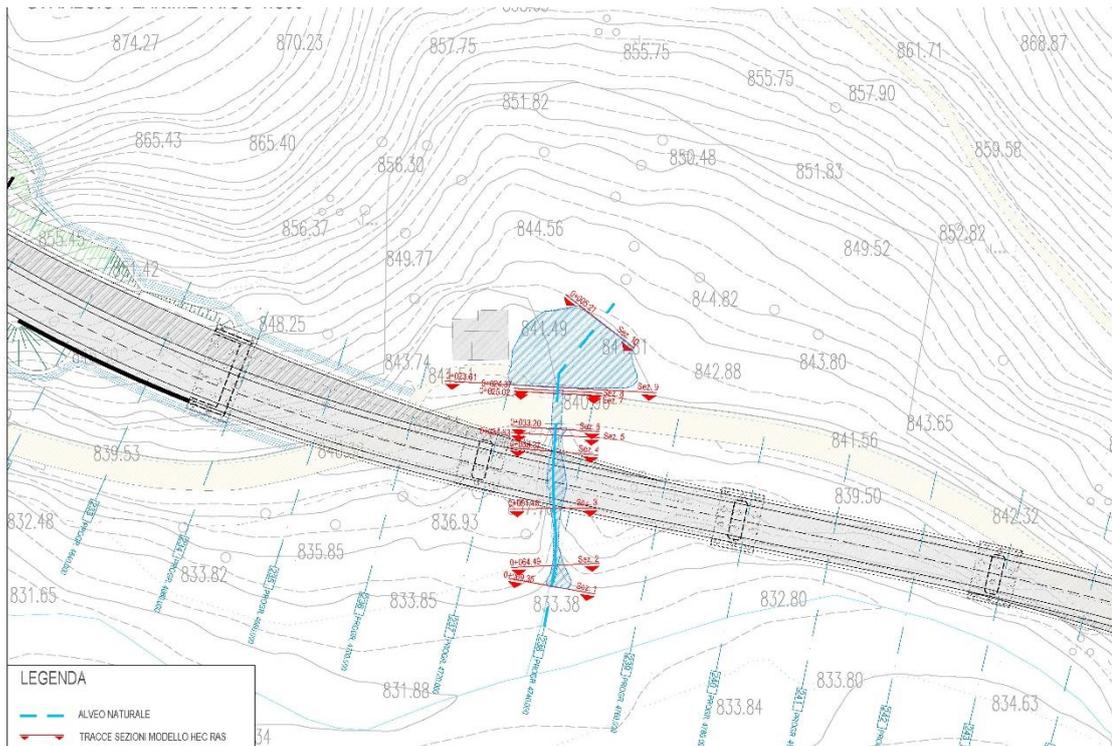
Fosso Fsn15– Planimetria aree di esondazione.
